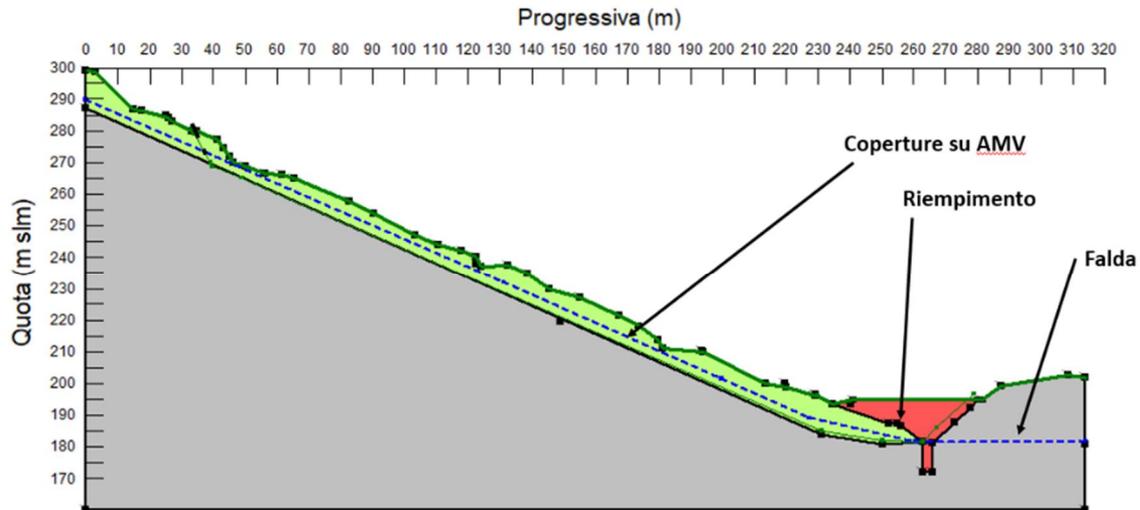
Sezione di calcolo – configurazione di progetto
